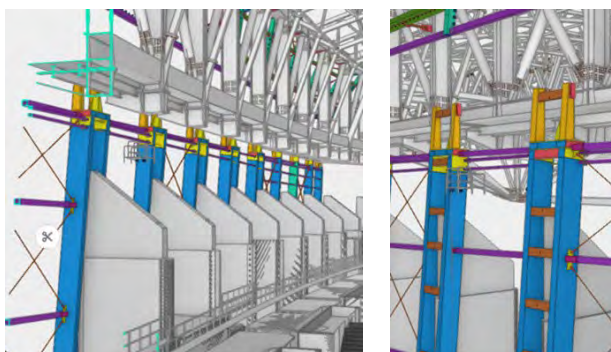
Modelo IFC: Fachada sur. Costillas en “diapasón” coordinadas con pilares de hormigón del graderío existente.
